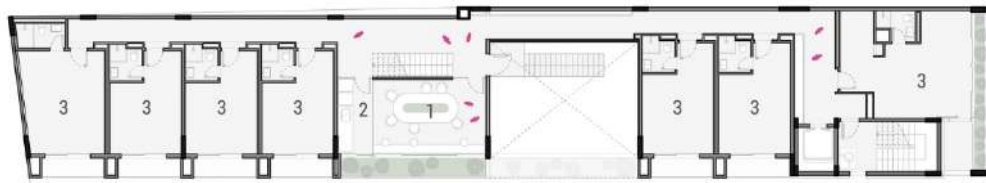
Planta 4º Pavimento – 1: Coworking. 2: Lavanderia. 3: Dormitórios.
